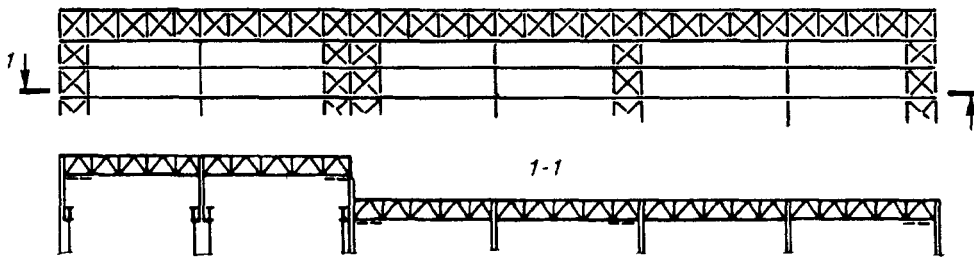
Размещение связей по поясам ферм в многопролетных зданиях
